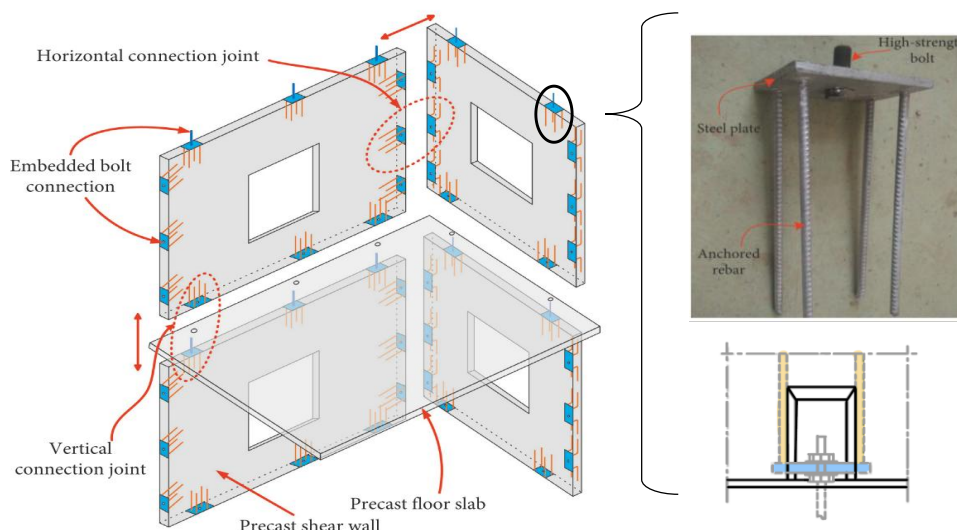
Exemplo de ligações entre paredes prefabricadas com caixas metálicas e parafusos, adaptado de [28].
